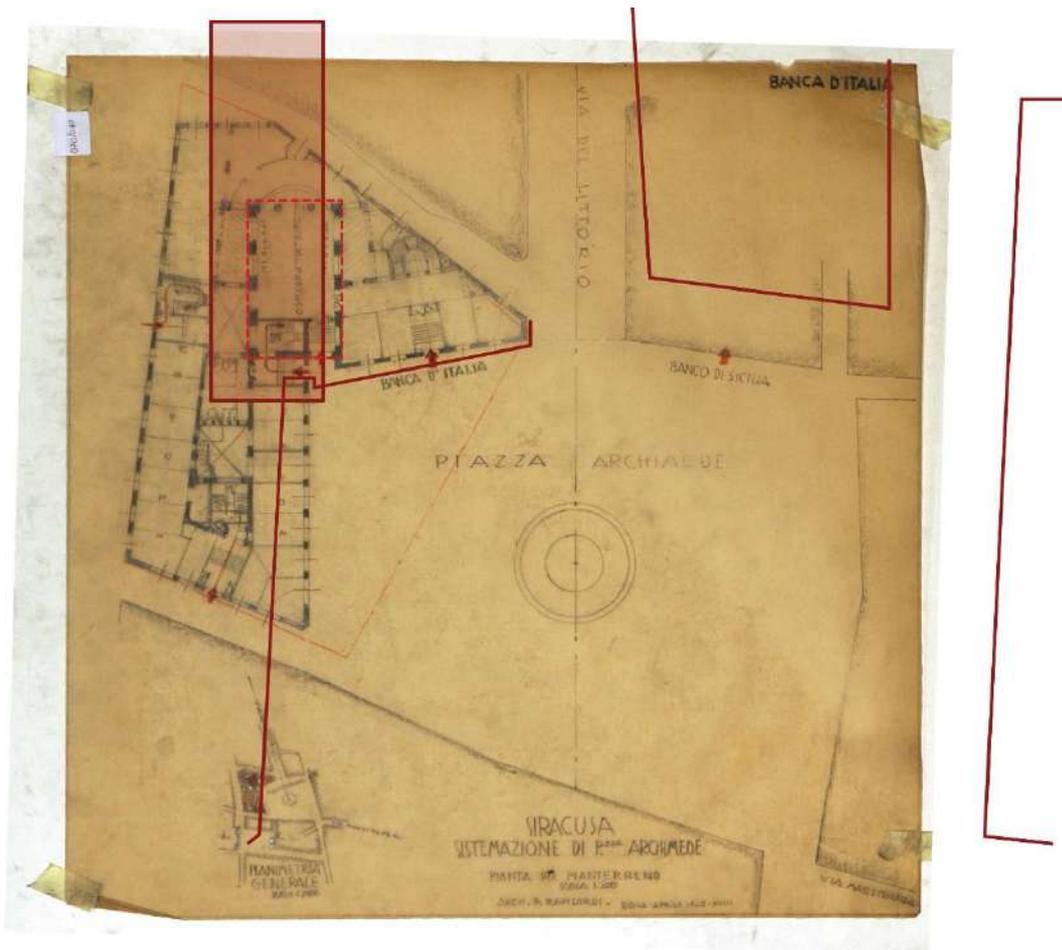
Confronto tra lo studio planimetrico di progetto e i limiti dei volumi, in rosso, ricavati dalla restituzione prospettica. Elaborazione dell'autrice.
